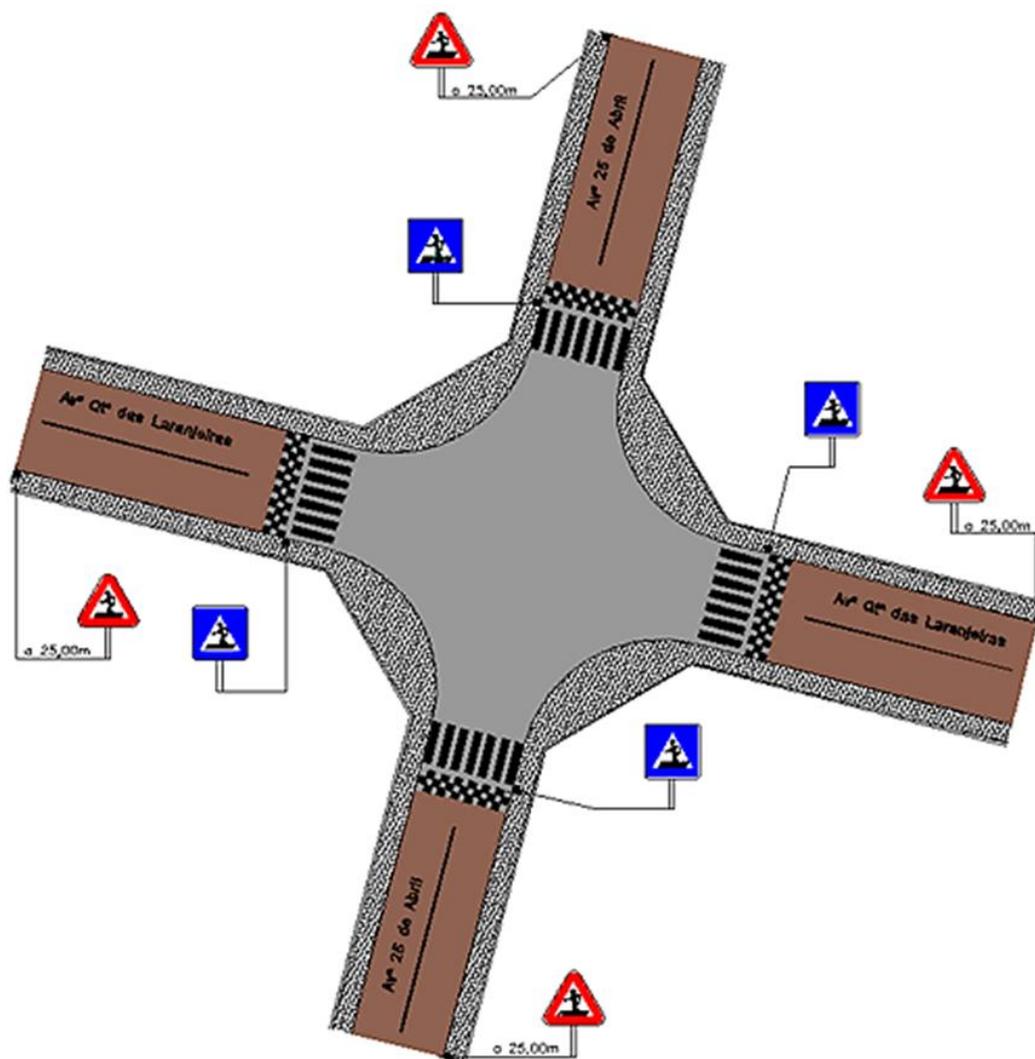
Planta de apresentação do projeto do cruzamento elevado
